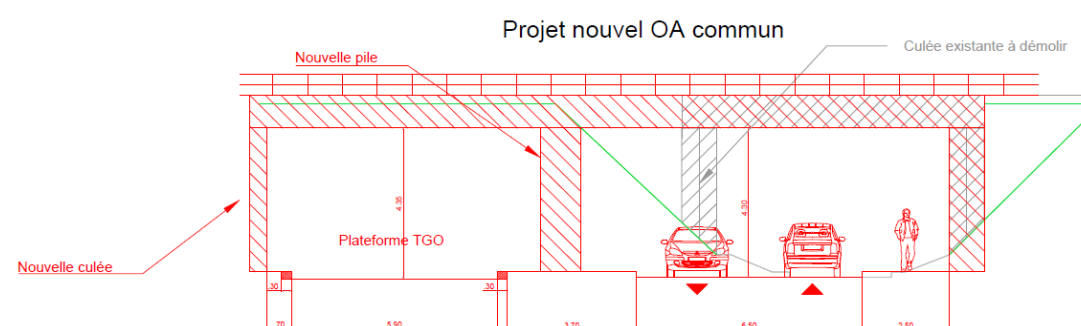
Coupe type du pont-rail d'Achères-Ville élargi
